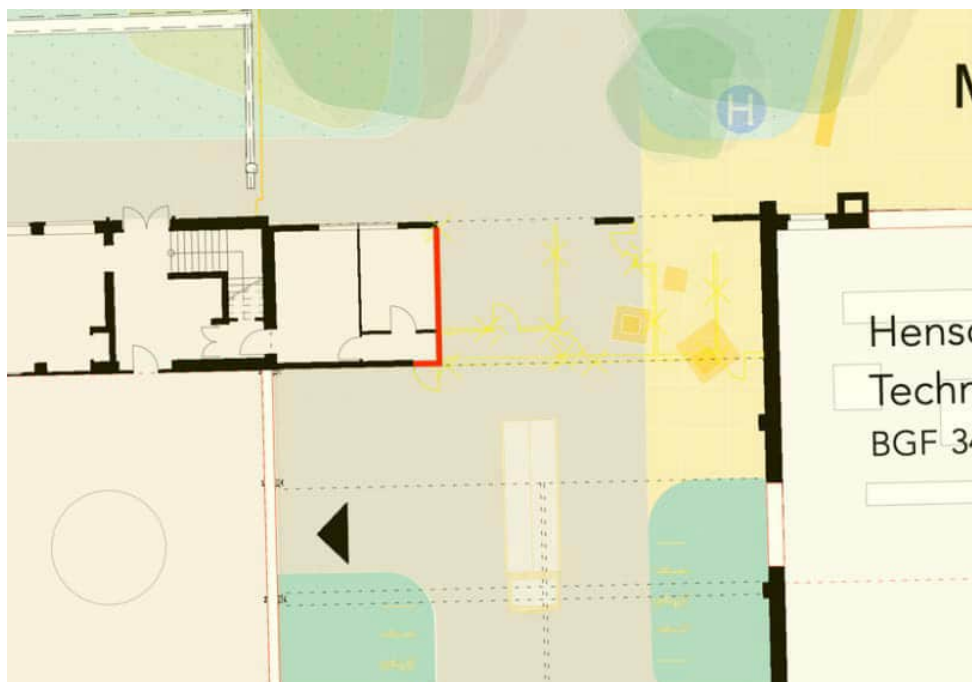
Grundriss Erdgeschoss R1 Schiff 1, coido architects
